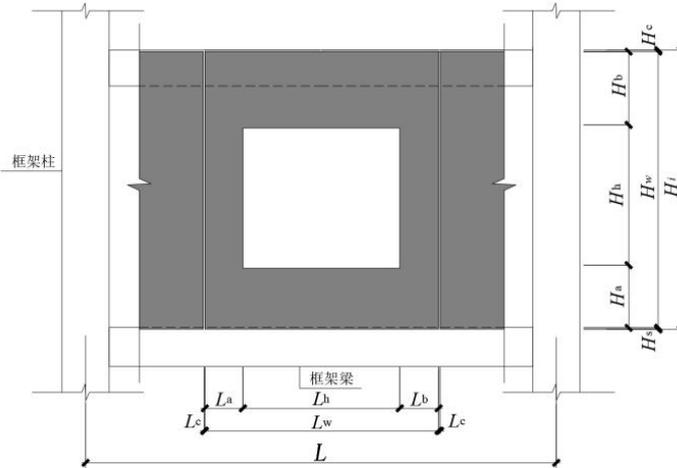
一个洞口预制混凝土外墙挂板编号规则示意图
